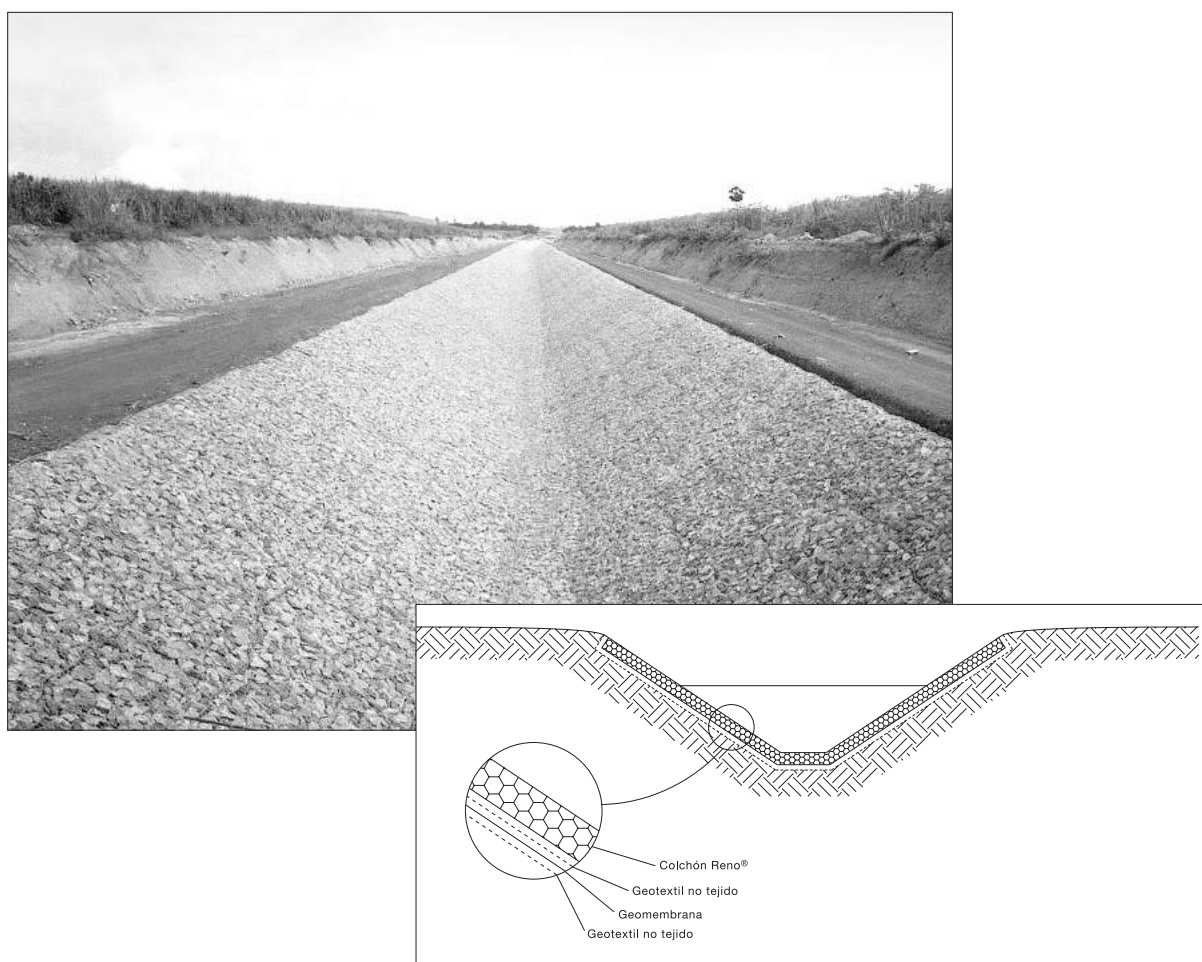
Revestimiento con colchones Reno® e impermeabilización con geomembrana Canal Pedrado Cavalo - BA - Brasil.
